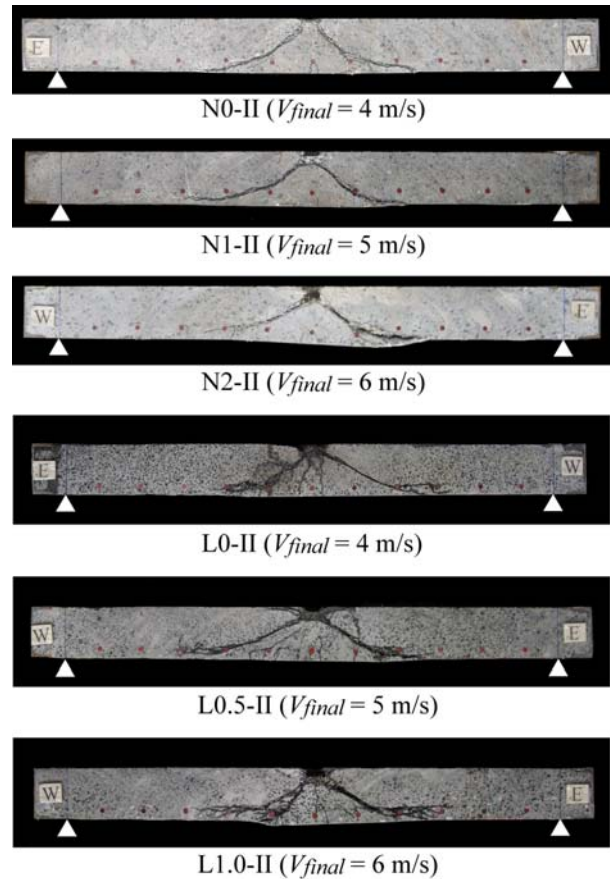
衝撃実験後の各試験体切断面のひび割れ状況
